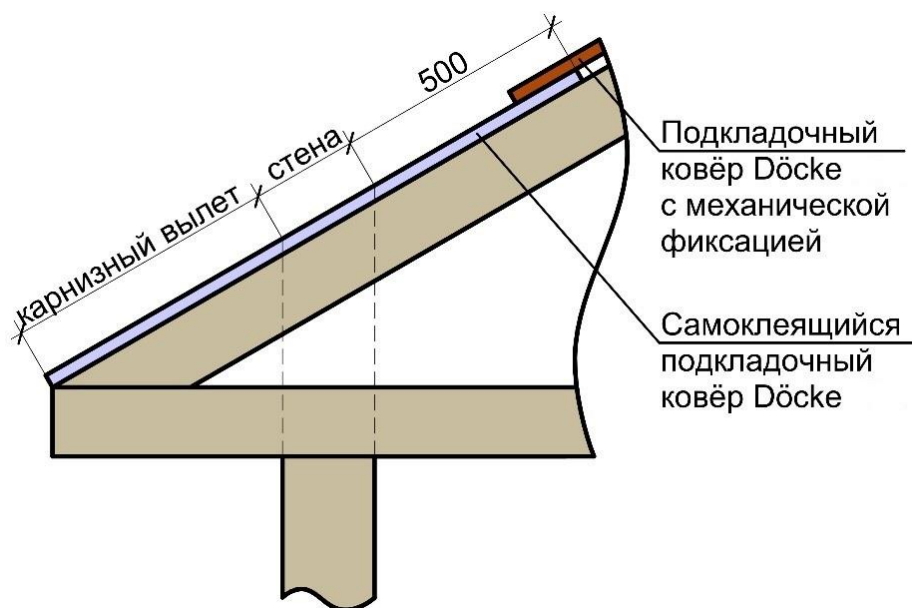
Схема укладки подкладочных ковров на карнизный свес.
